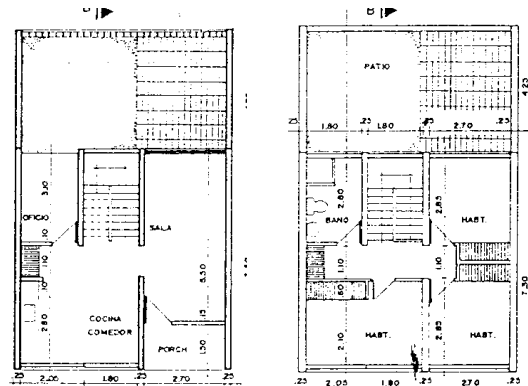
f. Casa CMD3A. Plantas Baja y Alta
